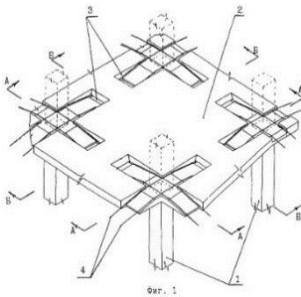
Монолитное преднапряженное перекрытие: 1 – колонны;
